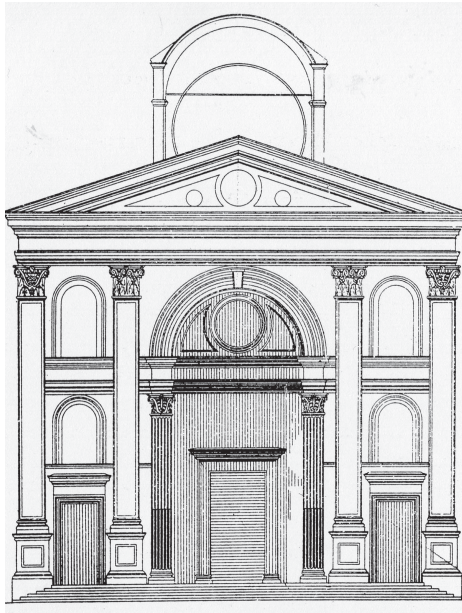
Sur la façade s'inscrivent les mesures de la place et celles du bâtiment, légèrement en retrait
